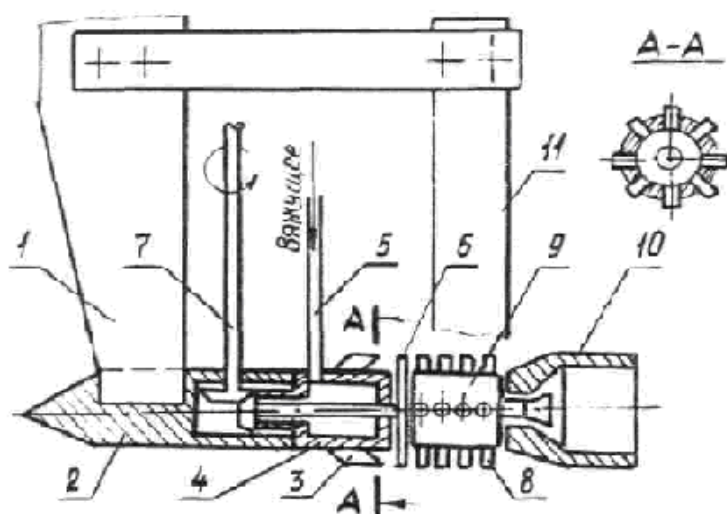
Рабочий орган для облицовки кротовин цементным раствором
